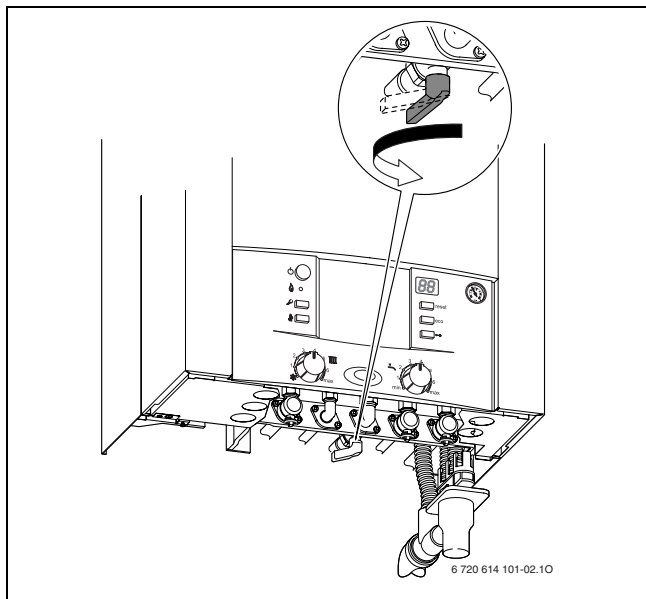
Vista caldaia con piastra d'installazione, accessorio nr. 893/18
